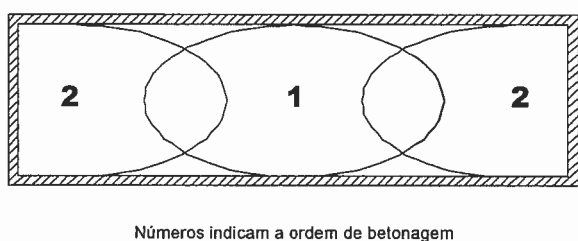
Procedimento para encher um molde de provete para ensaio de flexão.
